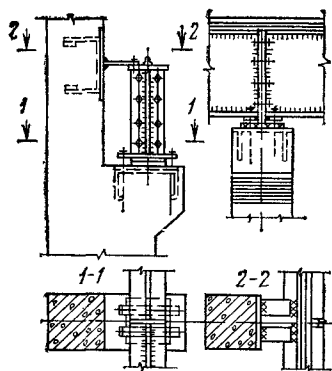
Опираие подкрановых балок на железобетонные колонны
